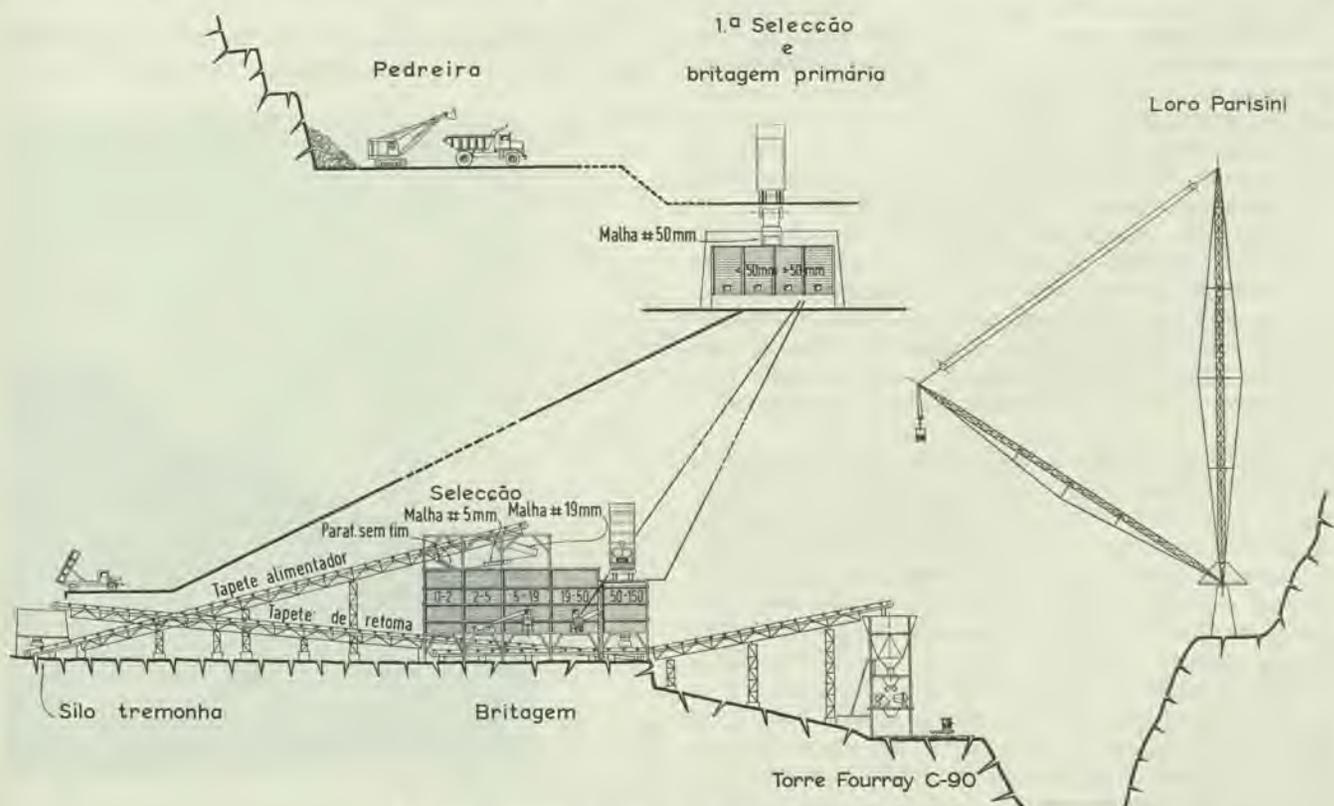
Esquema das instalações de fabrico e colocação de betão
